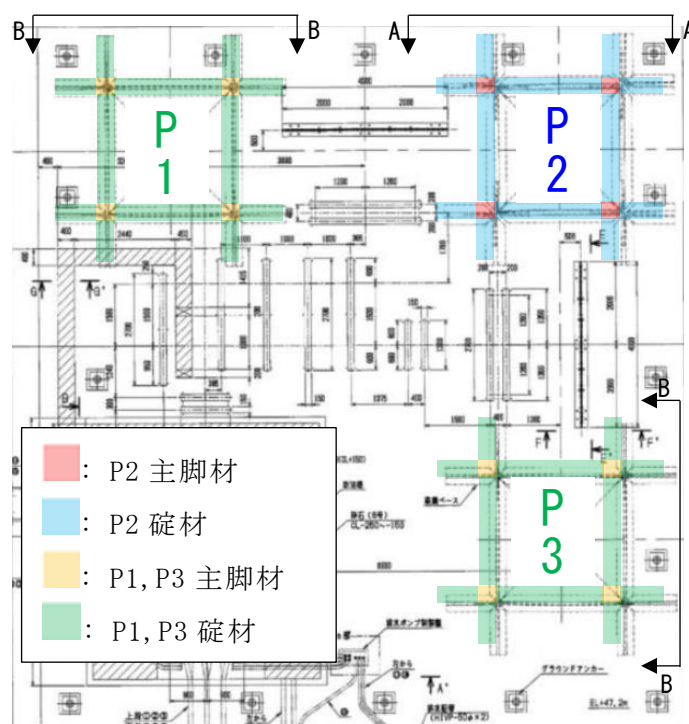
基礎コンクリート内の主脚材及び碇材の平面配置図
